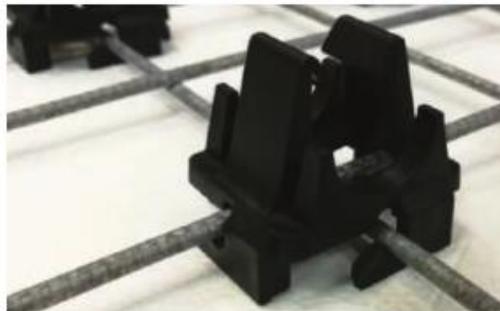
Крепление труб к сетке пластиковыми клипсами.
